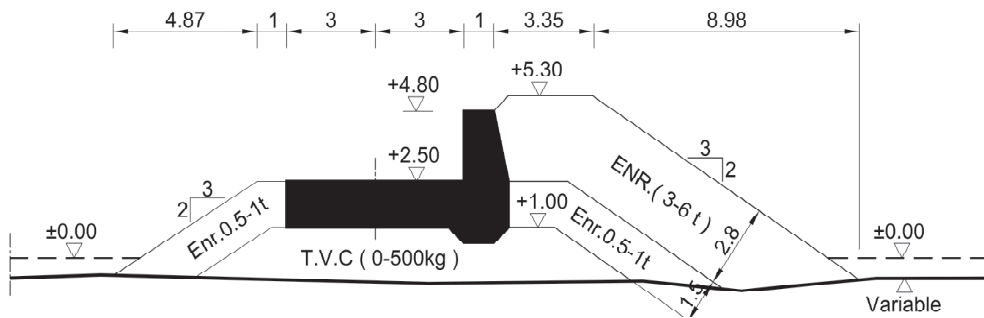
Coupe transversale du profil enracinement de la jetée secondaire
